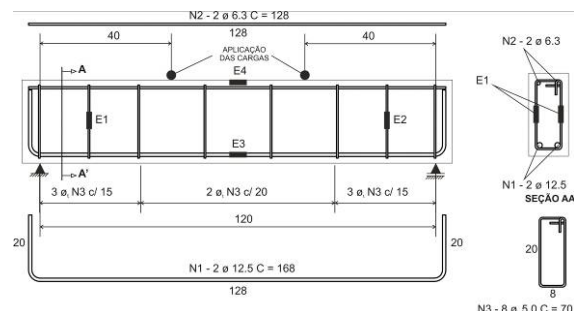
Detalhamento das armaduras da viga e posicionamento dos *strain-gages*.
